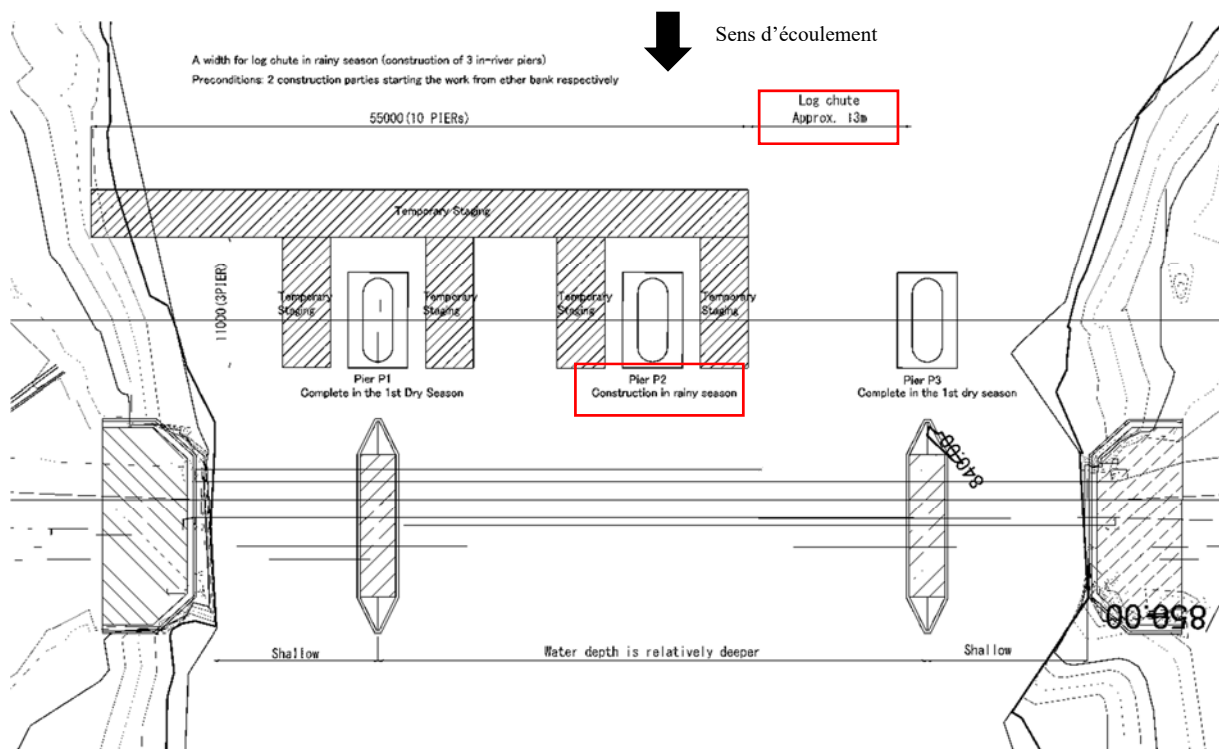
Section transversale d'écoulement lors des travaux de construction à la saison des pluies dans le cas de 4 travées
